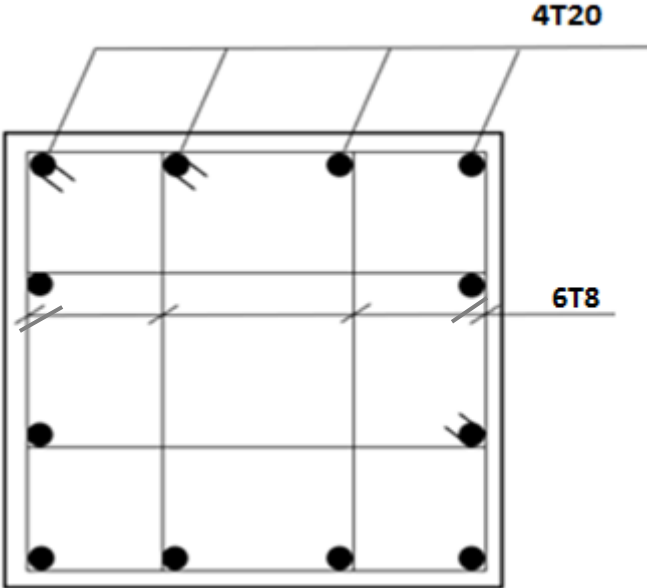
Schéma de ferrailage du poteau 55x55
